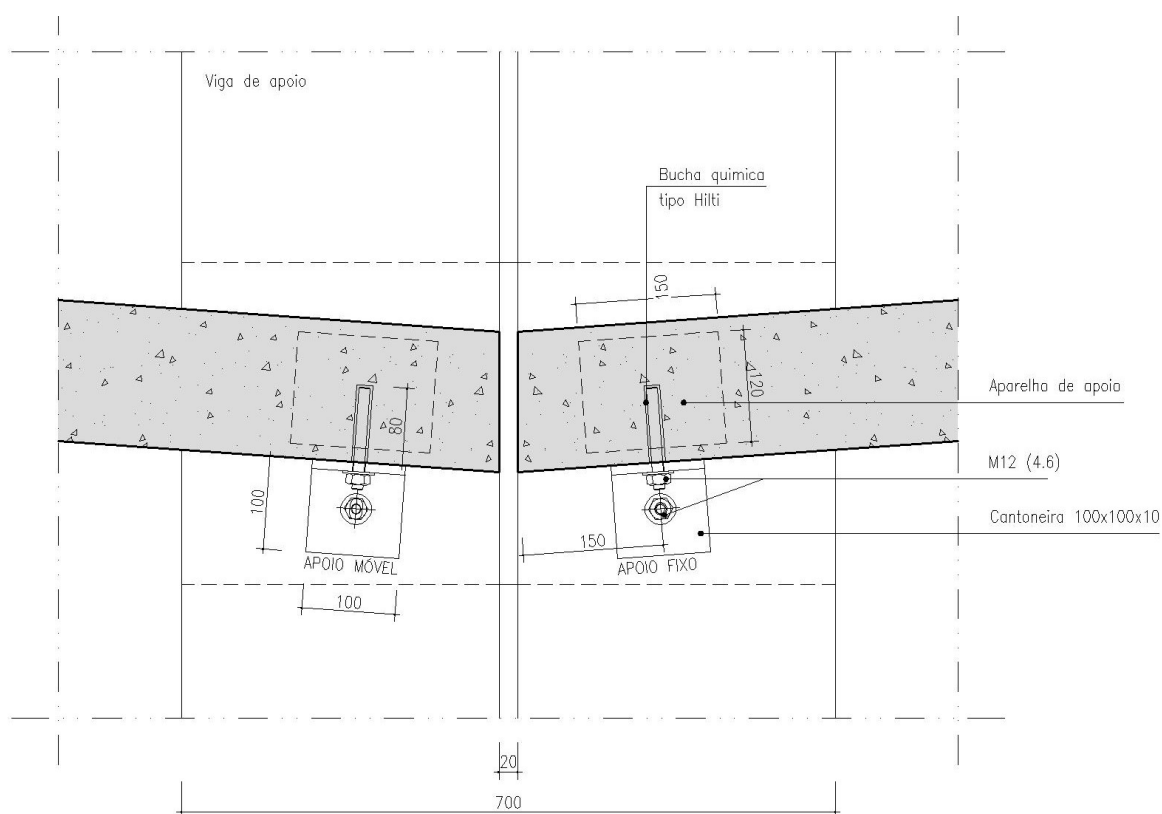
Zona de apoio dos degraus nas vigas de bancada.
